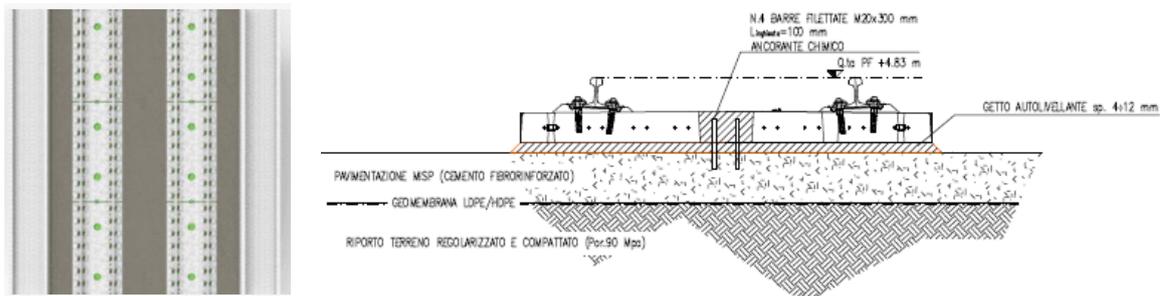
Soluzione Ballastless; pianta e sezione tipo
